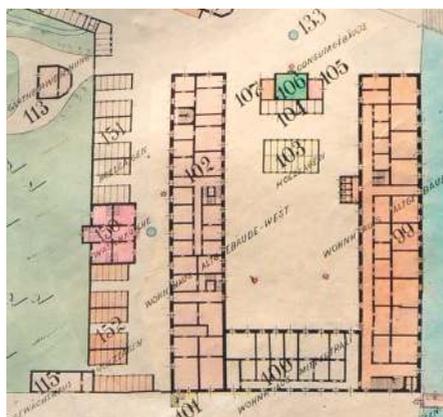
(oben): Grundriss Arbeiterwohnhaus Altgebäude (ehem. Theresienmühle);
